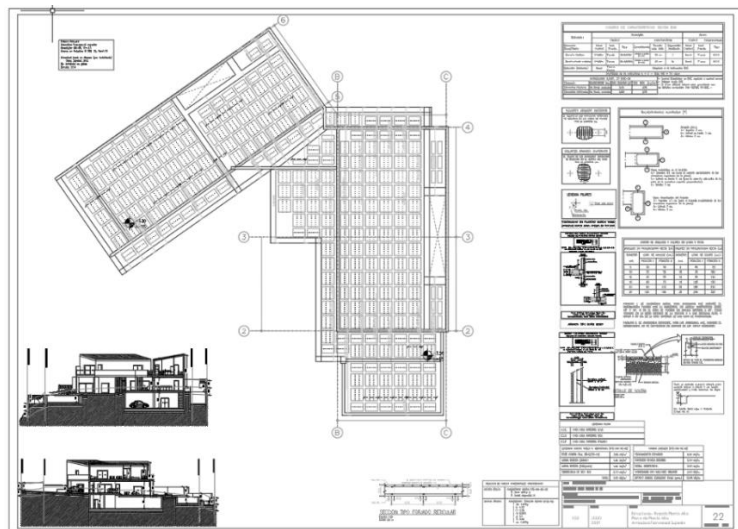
Ejemplo Planos de Ejecución (BERLIN)
